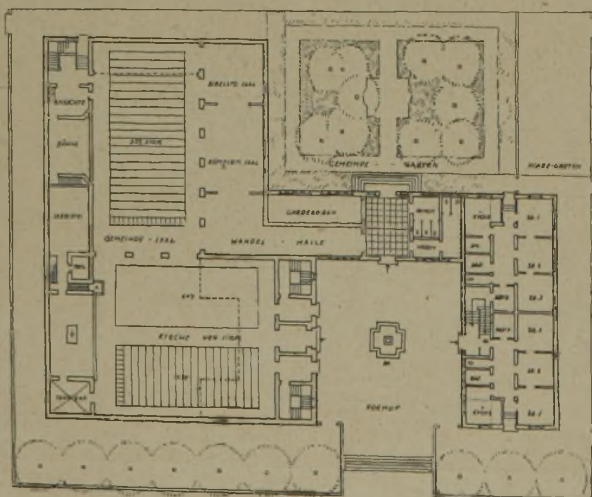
Grundriß vom Erdgeschoß. (1 : 800.)
